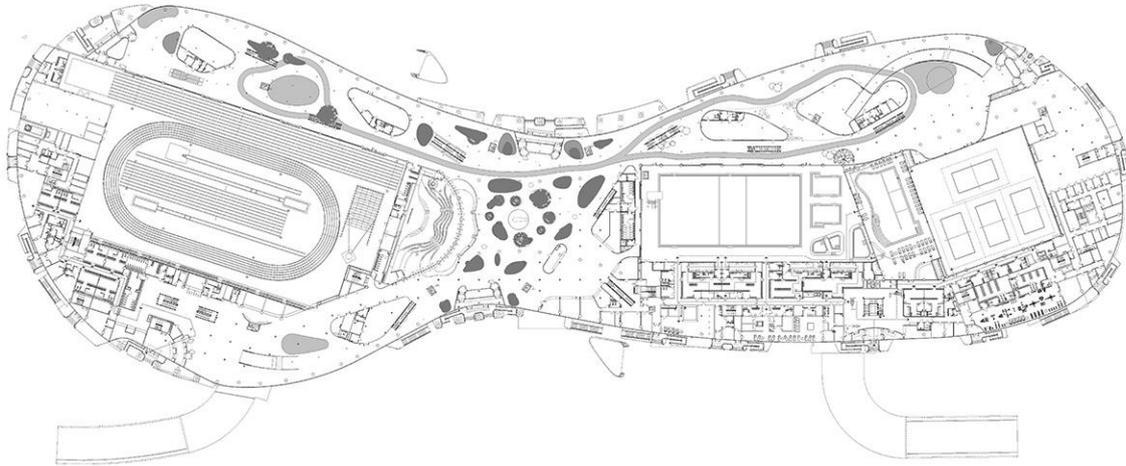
Пешеходная галерея – променад в Новом Уренгое. План 1-го этажа
